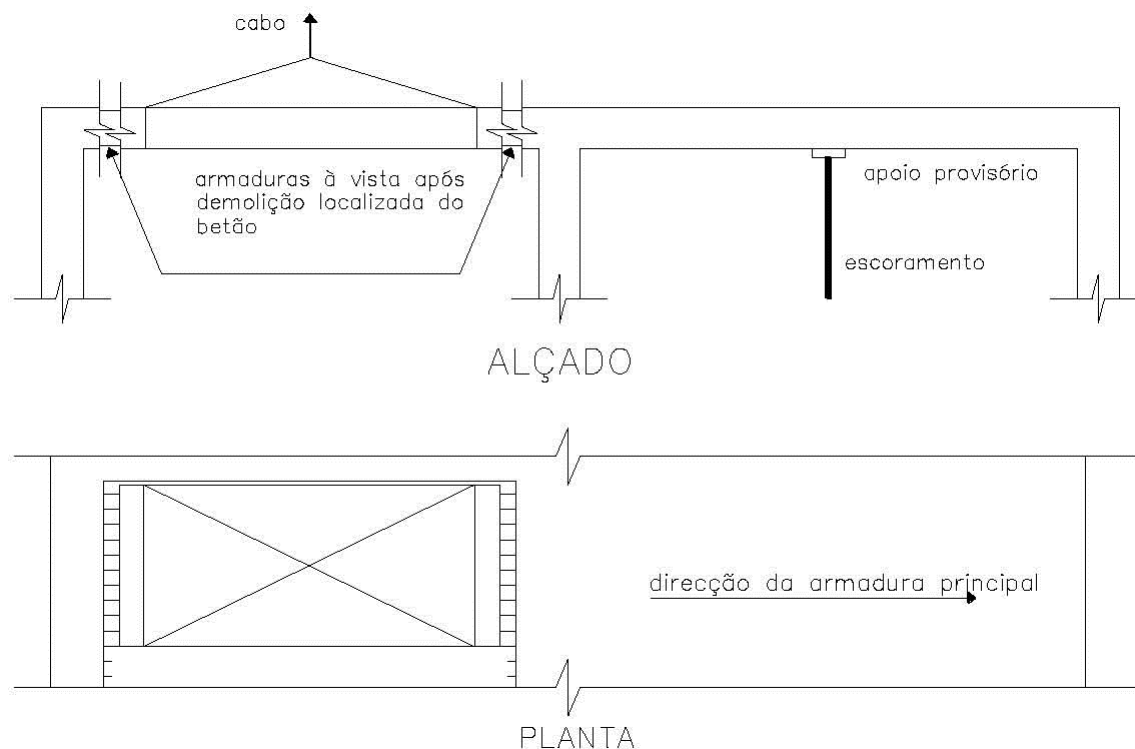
1 – Corte e remoção de uma laje vigada tradicional armada numa só direcção (Fonte: Brito, Jorge, 1999)
